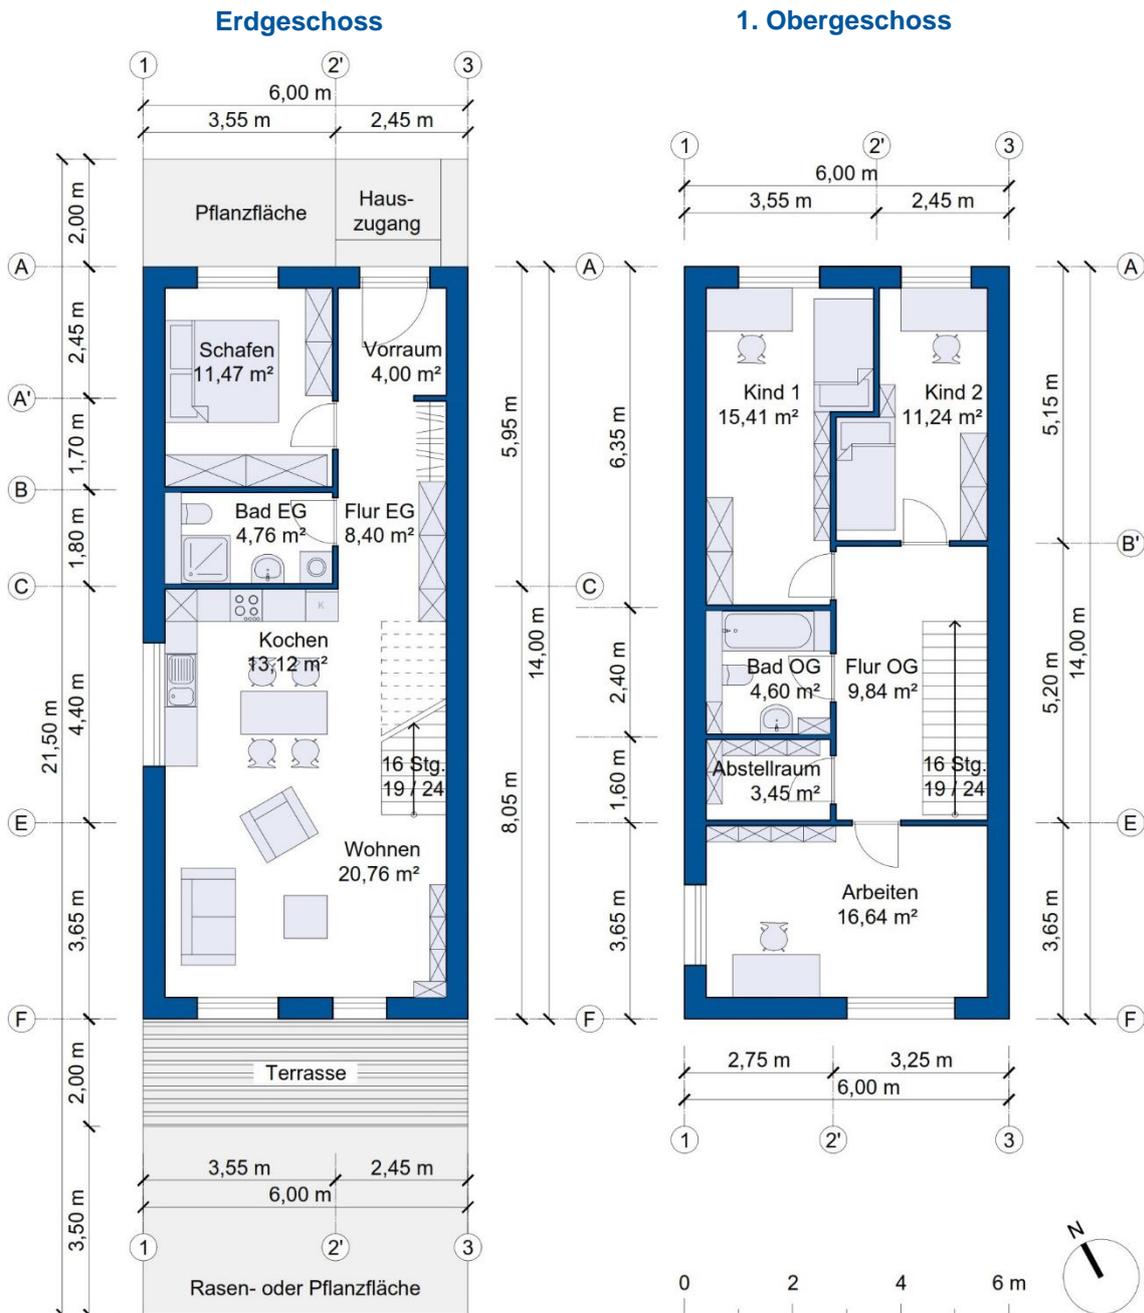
Beispielhafte Grundrissgestaltung EG und 1. OG
